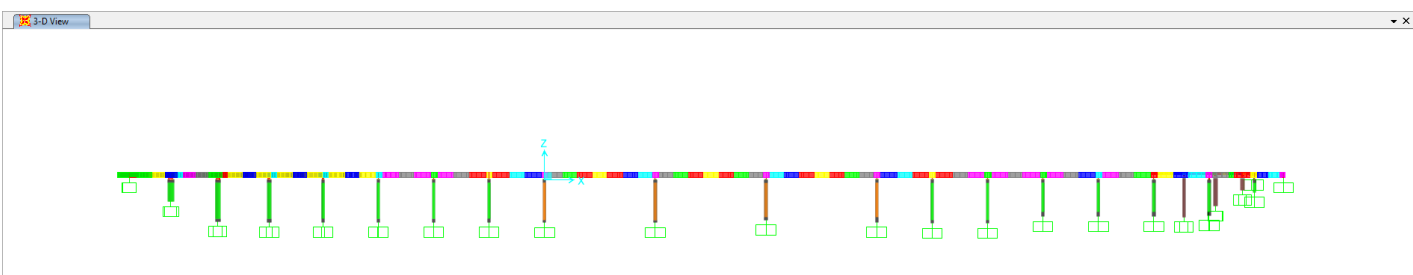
Modello globale 3D con vista estrusa, prospetto frontale
